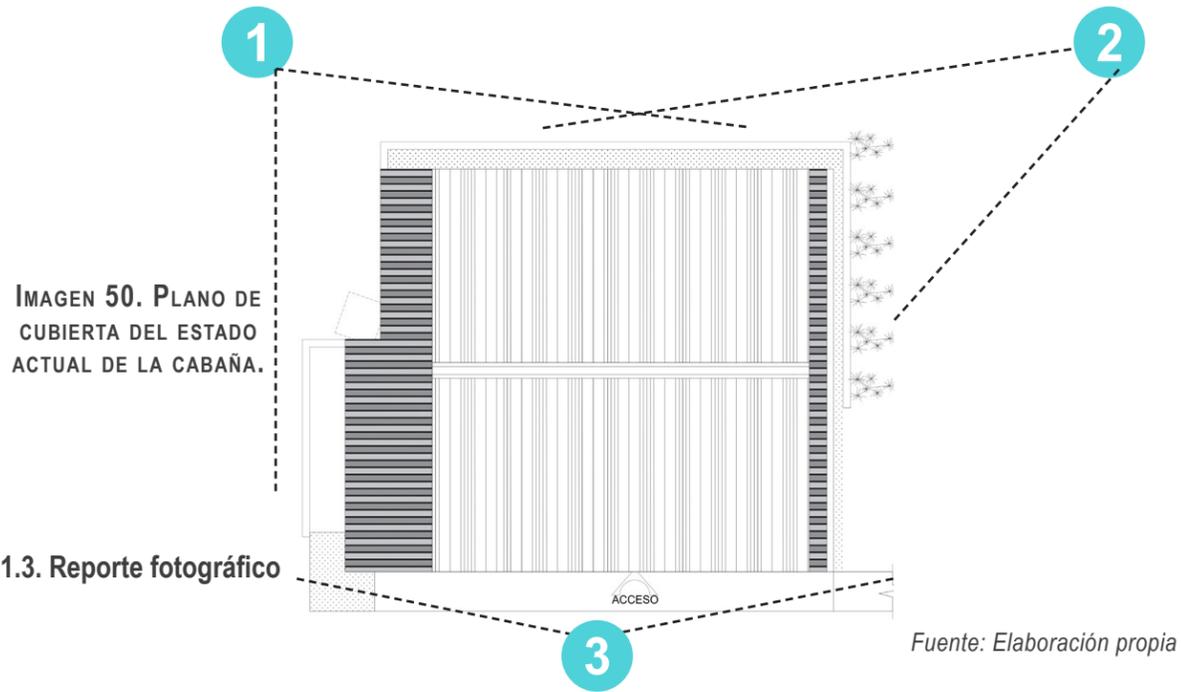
PLANO DE CUBIERTA DEL ESTADO ACTUAL DE LA CABAÑA.
